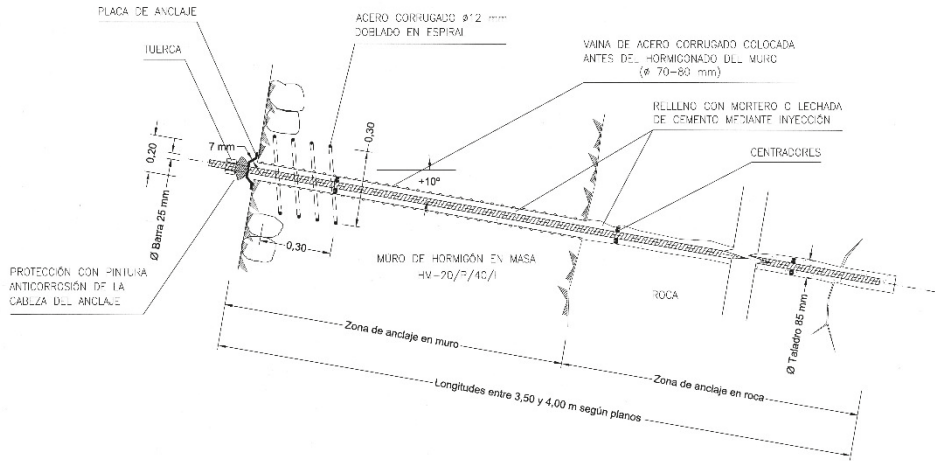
Detalle de anclaje pasivo adherente en la base del muro. (Pueden apreciarse las dos zonas diferentes del anclaje: en la roca se inserta en los taladros previamente perforados; dentro del muro, en las vainas de acero corrugado previamente colocadas en el interior del hormigón).
